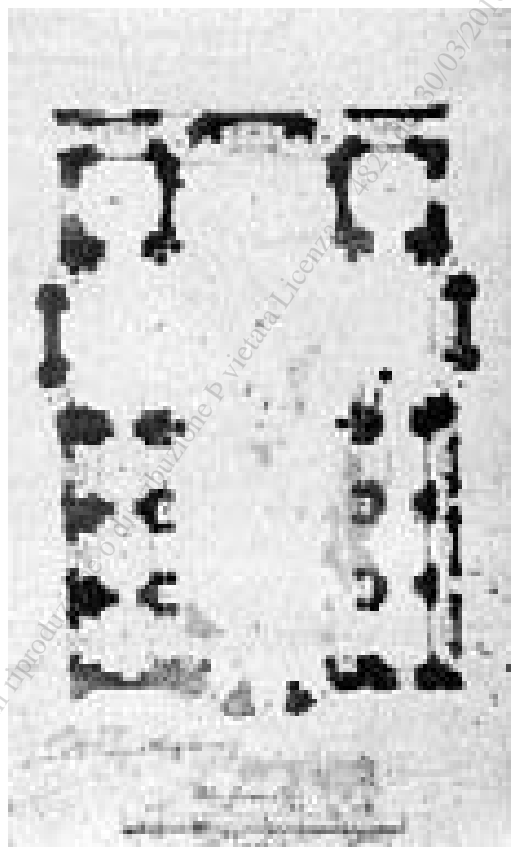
Progetto per la chiesa degli Oratoriani: pianta (GDSU, 2252 A)
